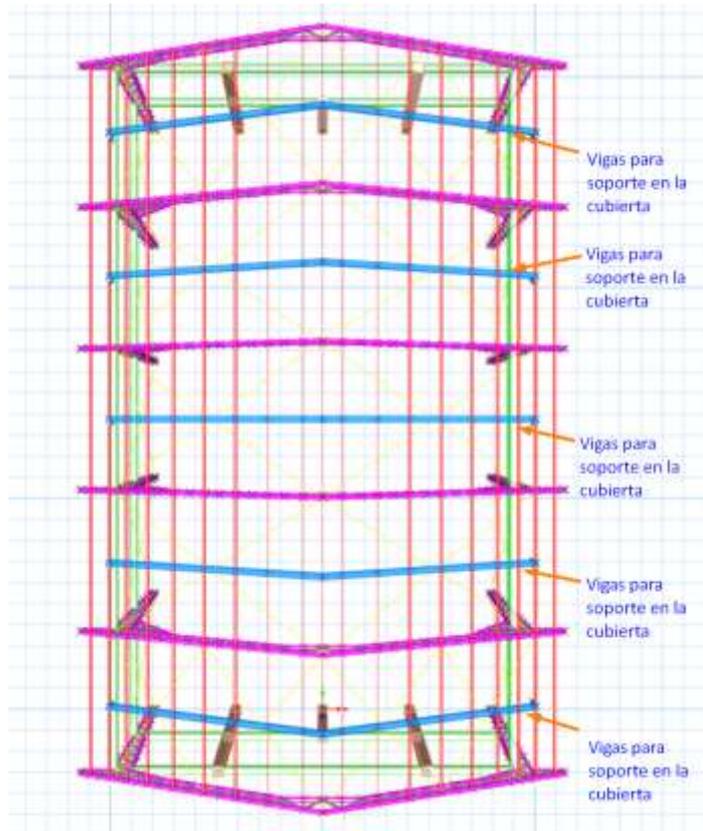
Localización de las vigas de soporte del sistema de la cubierta
